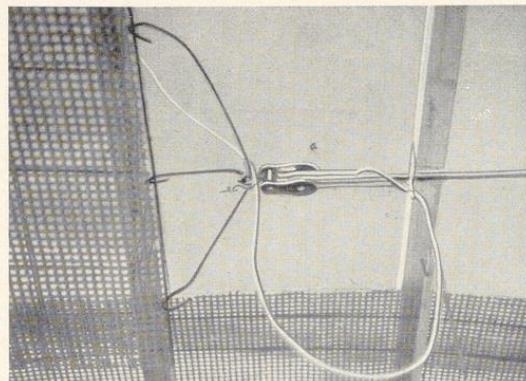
Flaschenzug mit einer Rolle zum Spannen des Drahtgewebes
